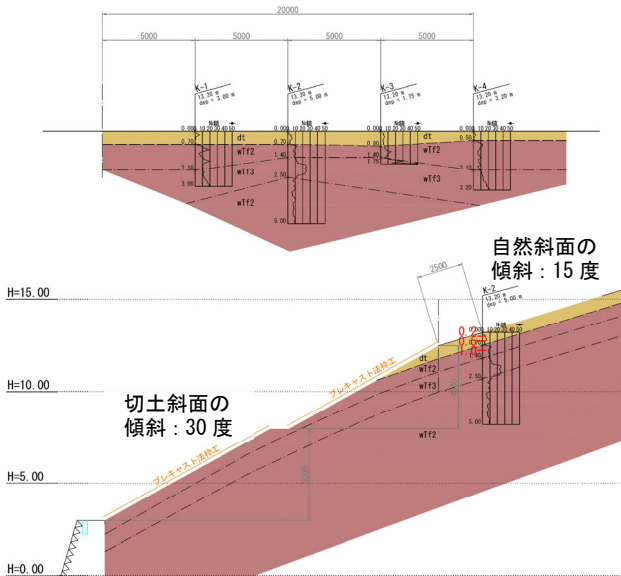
調査地の断面図 (上: 横断面図, 下: 縦断面図)
